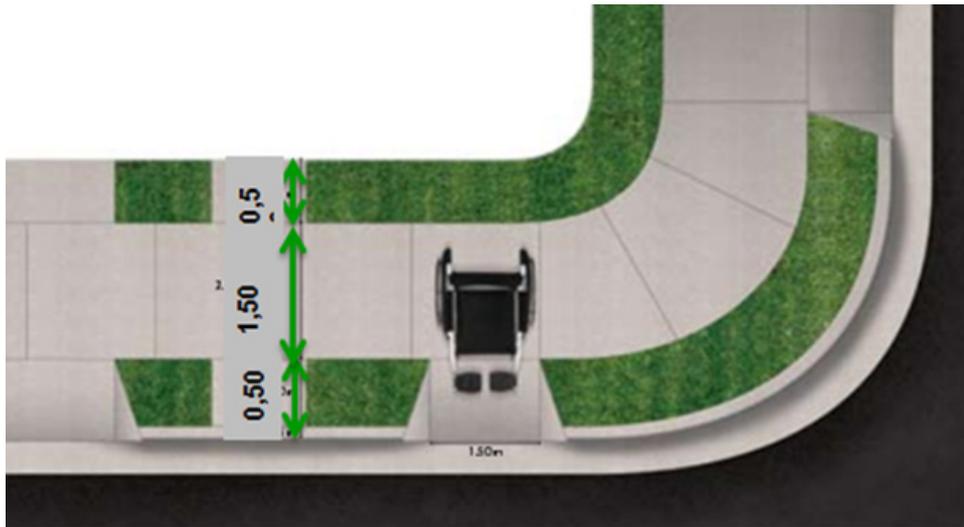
Croquis esquemático de Calçadas Verdes - planta
